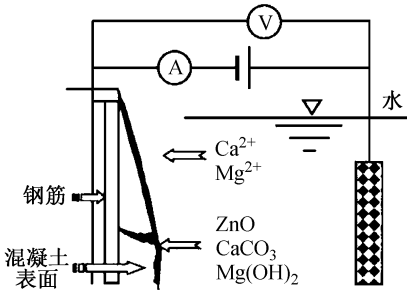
电化学沉积修复钢筋混凝土裂缝原理
